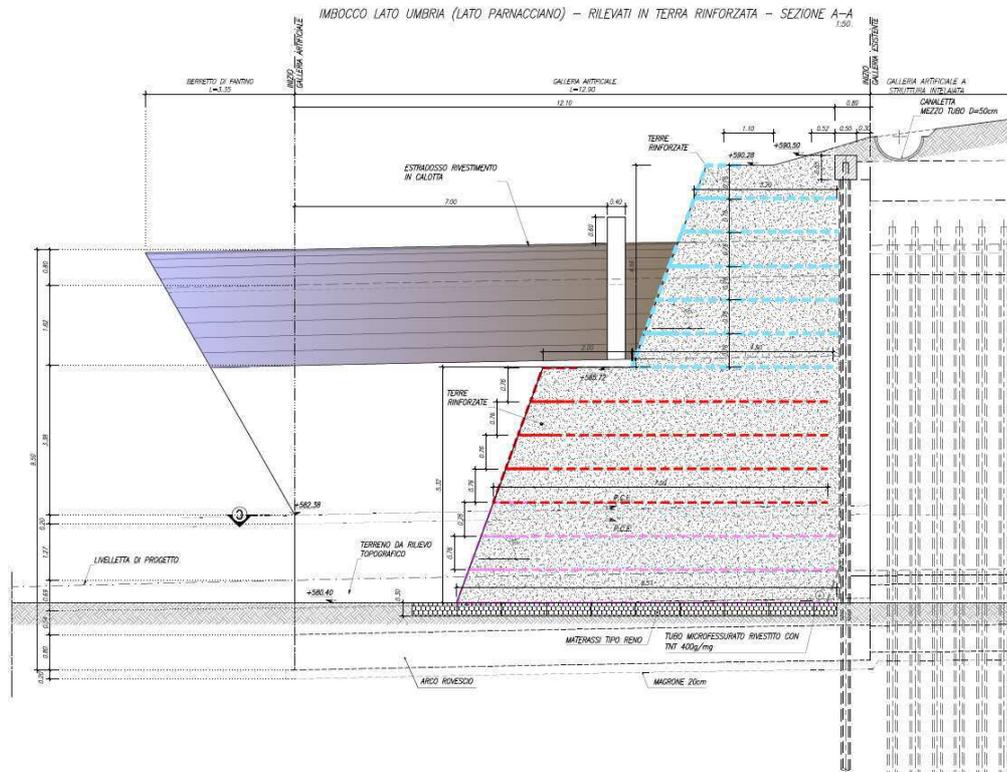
Rilevato rinforzato a tombamento della paratia di imbocco: sezione tipo
